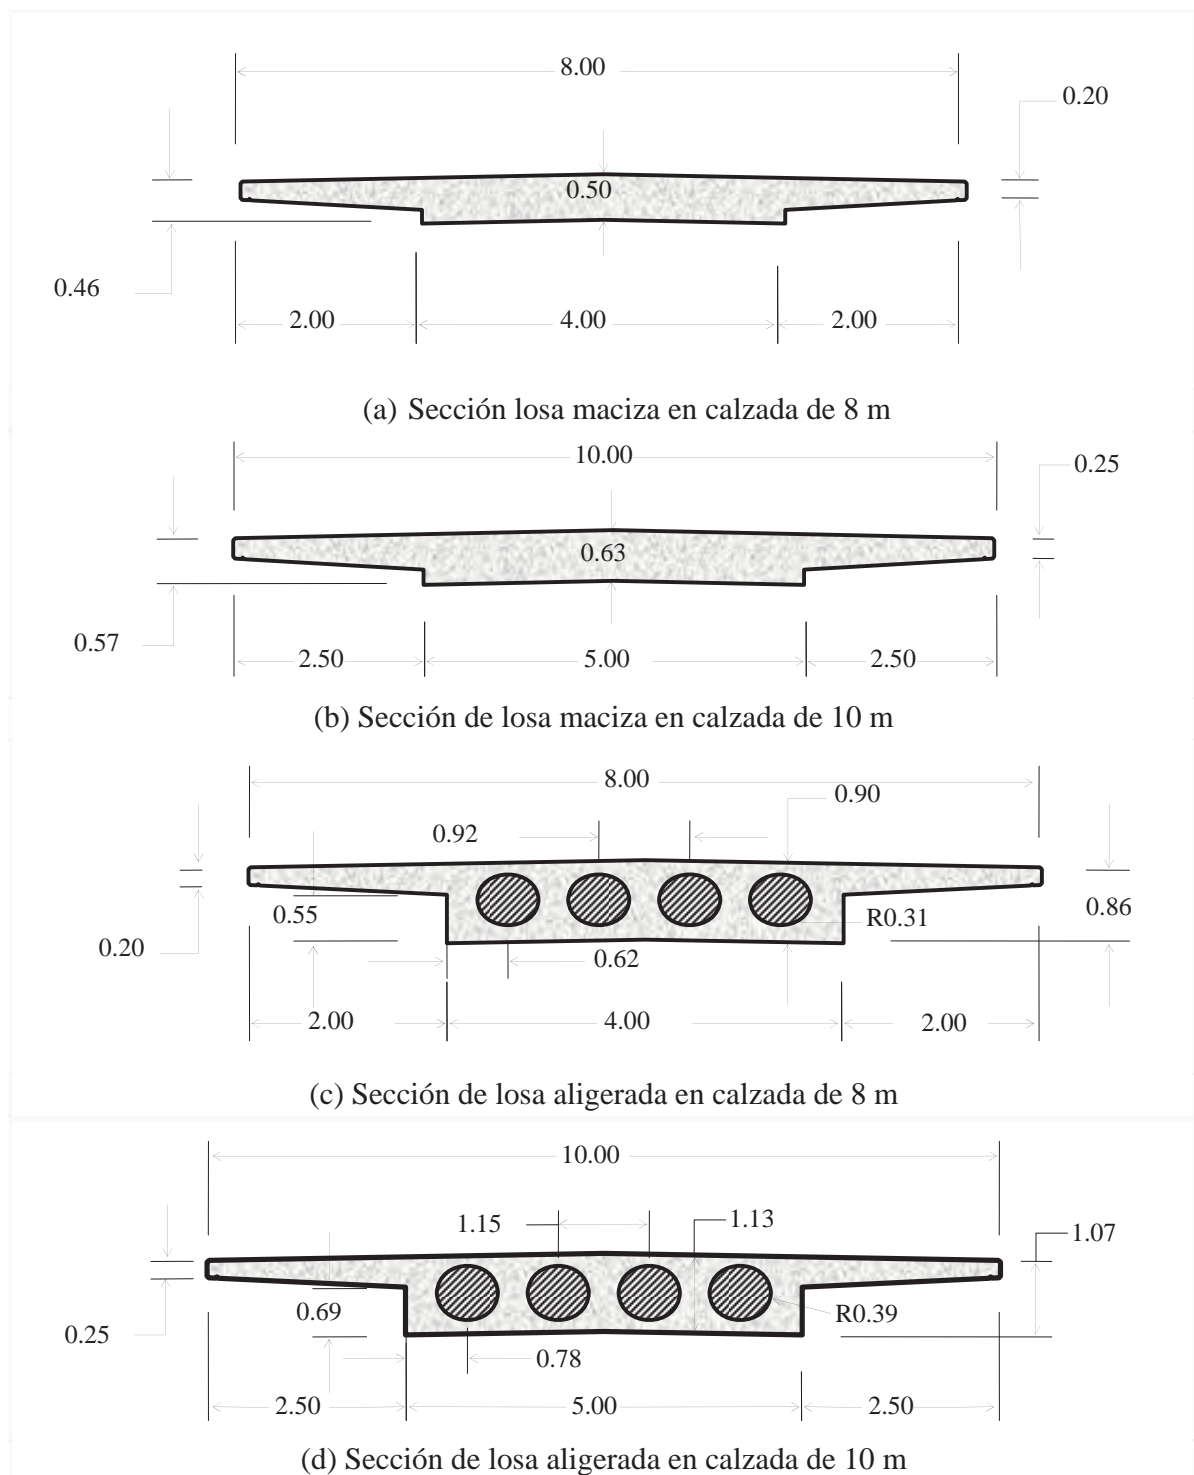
secciones transversales de losas tipo maciza y aligerada
